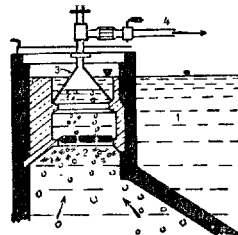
Деталь устройства для улавливания газа: 1—отстойный лоток; 2—деревянная решетка; 3—железный конус; 4—газовый отвод.
